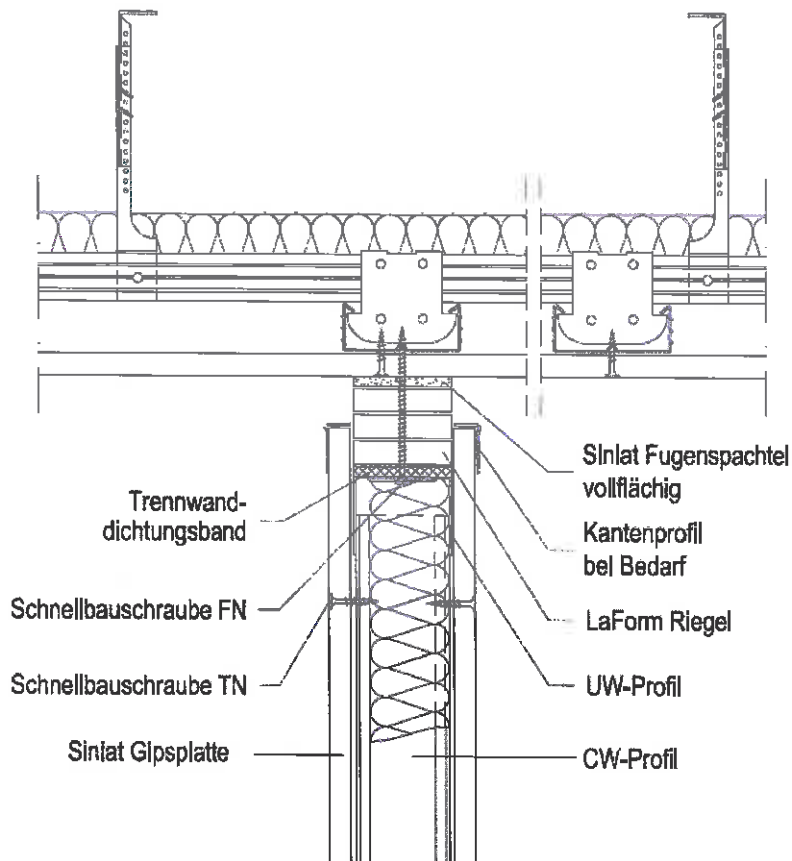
Deckenanschluss mit durchgehender Bekleidung
